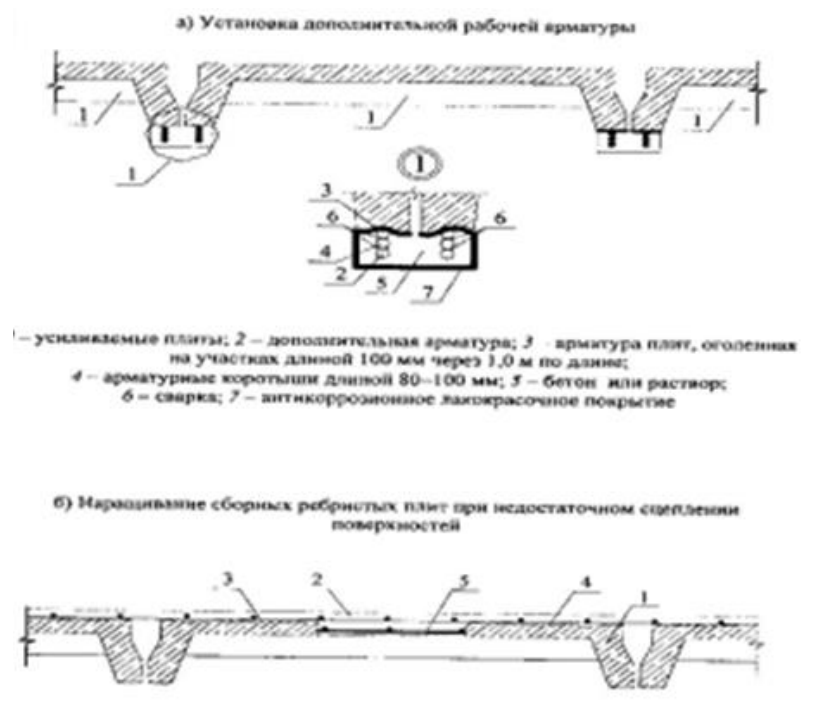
Усиление сборных железобетонных плит перекрытия и покрытия: 1 – усиливаемые плиты; 2 – монолитный слой бетона; 3 – конструктивная арматура усиления; 4 – поверхность сцепления монолитного бетона с плитой; 5 – вырубленные участки полог плит с сохранением арматурных сеток
